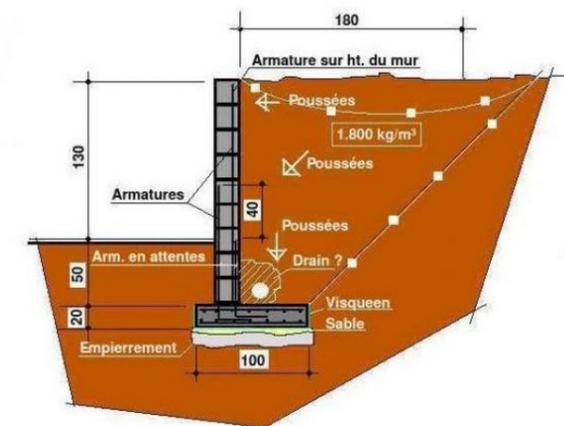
Mur de soutènement Source : <https://www.bricozone.be/t/mur-de-soutenement.87365/>
